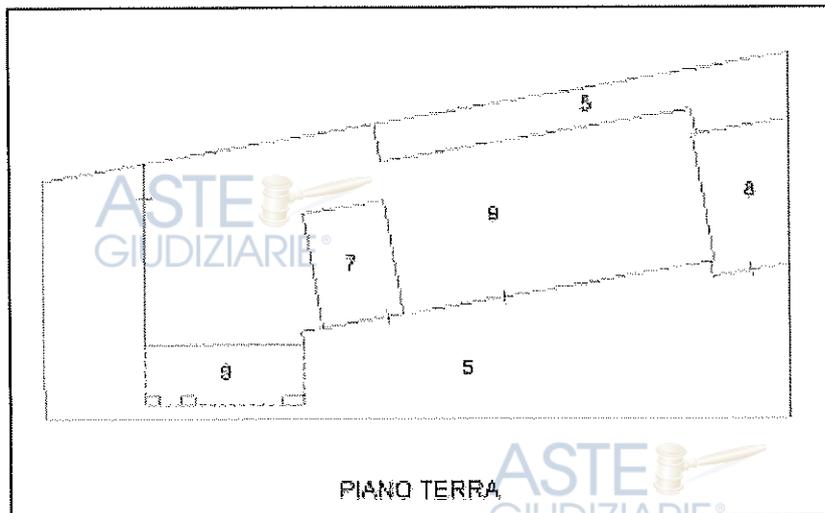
Estratto dell'elaborato planimetrico (piano terra)
